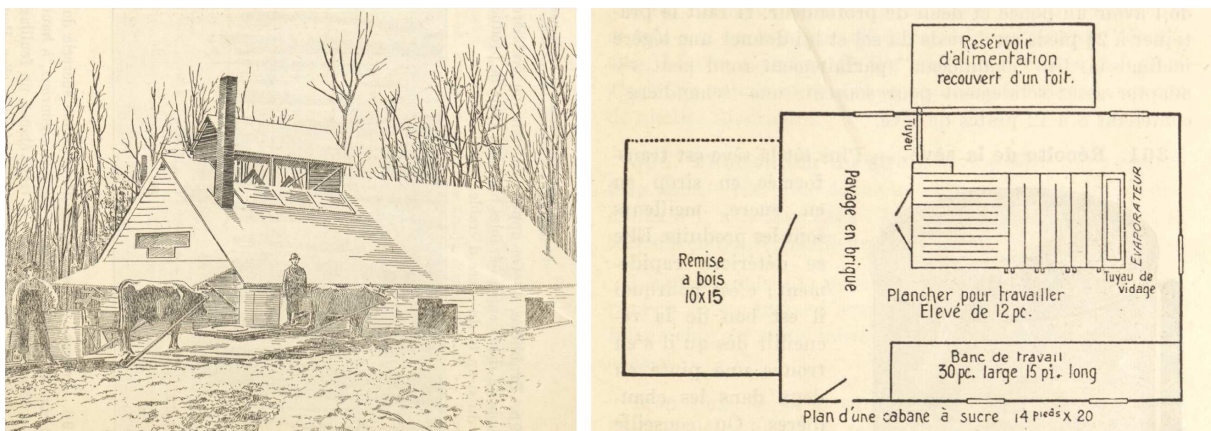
Plan et croquis d'une cabane à sucre, 1922
